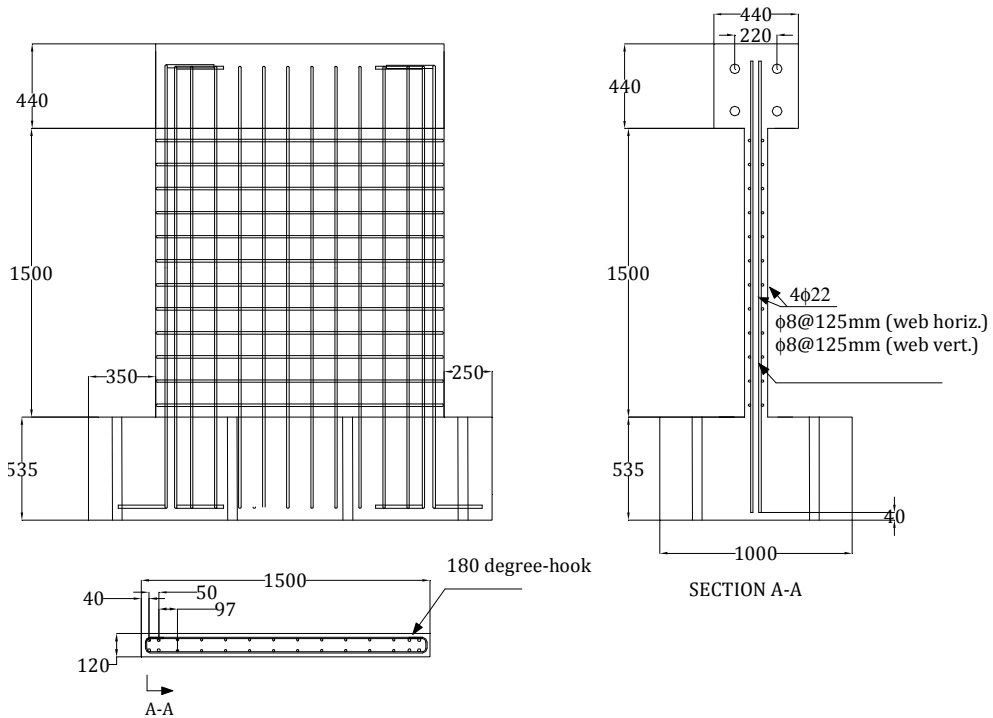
Geometría y detalle de armadura de muro Tipo 6.
